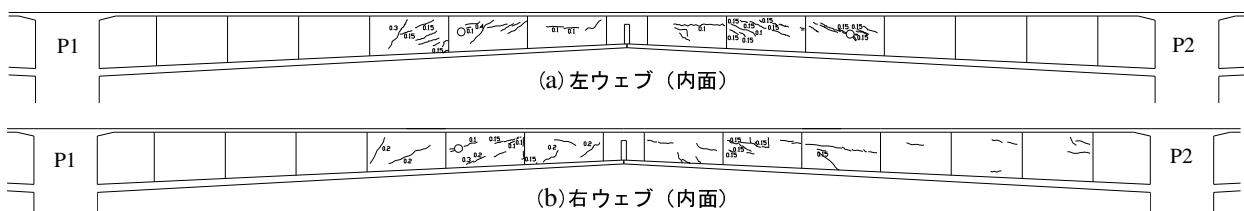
ひび割れ性状図 (P1~P2 径間)
